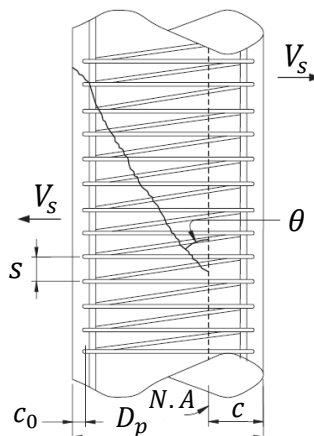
Mecanismo de falla por corte en el tapón de hormigón confinado.
